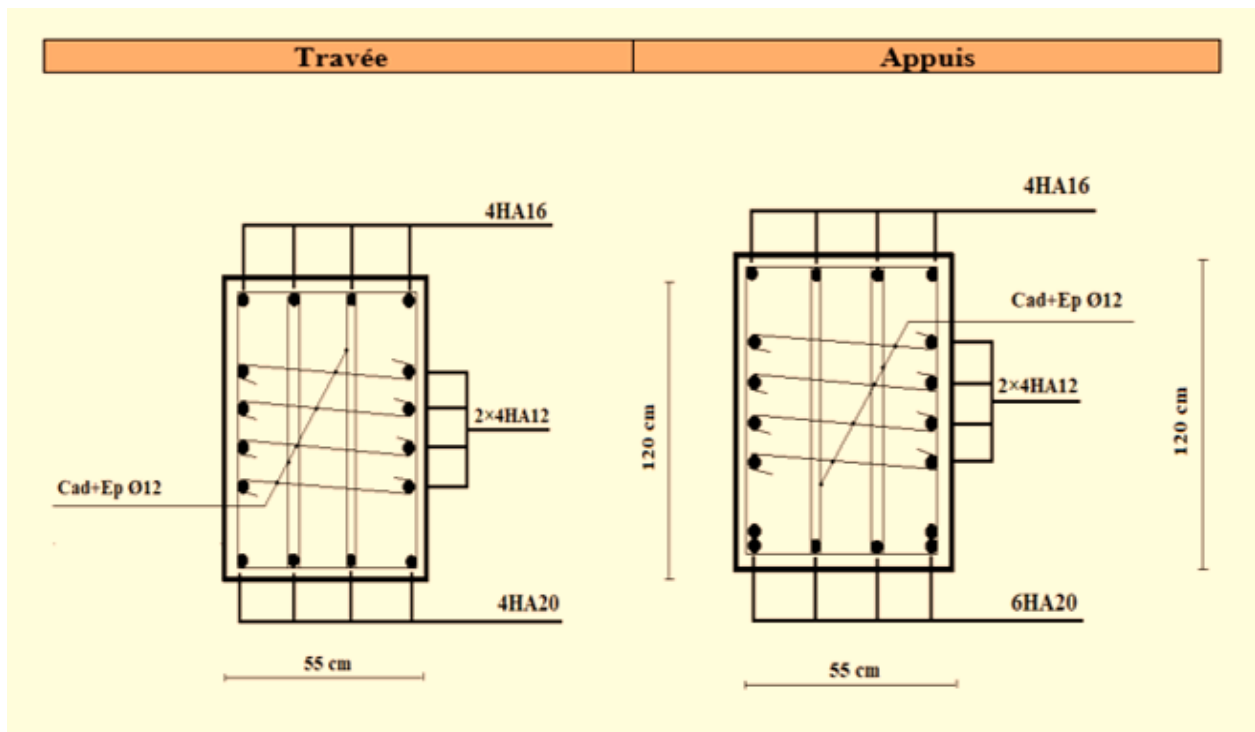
Coupe de ferrailage des nervures sens (Y-Y).
